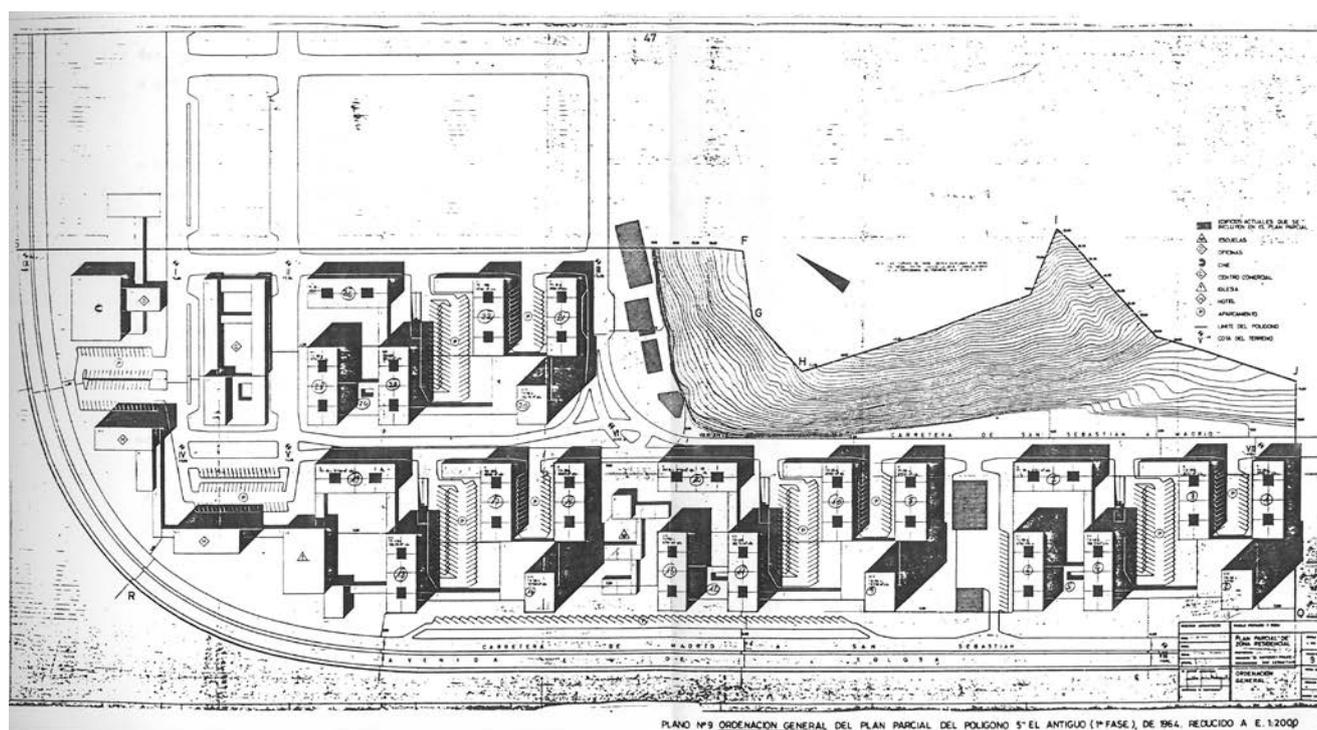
Plano de ordenación general del Plan Parcial - Pablo Pintado - 1964 - I. A. M.. Pág. 47
